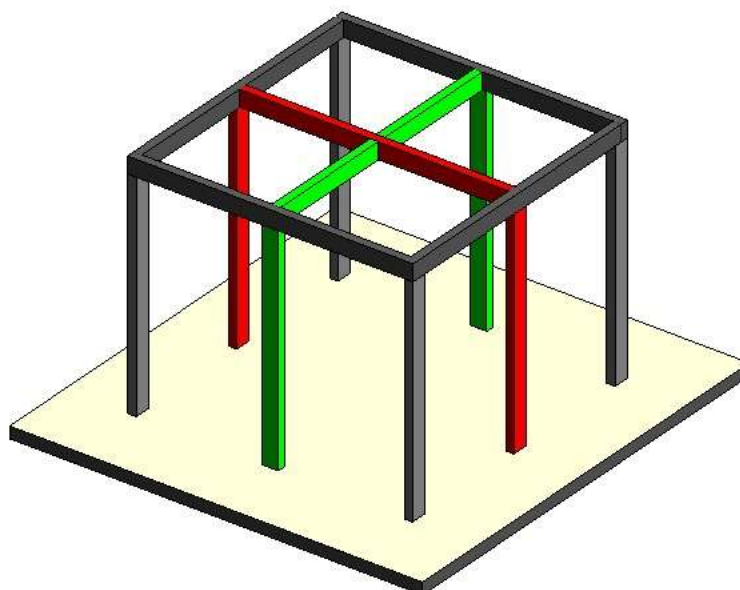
Concepção A: Mínimo de pilares, máximo de vigas apoiadas em vigas
